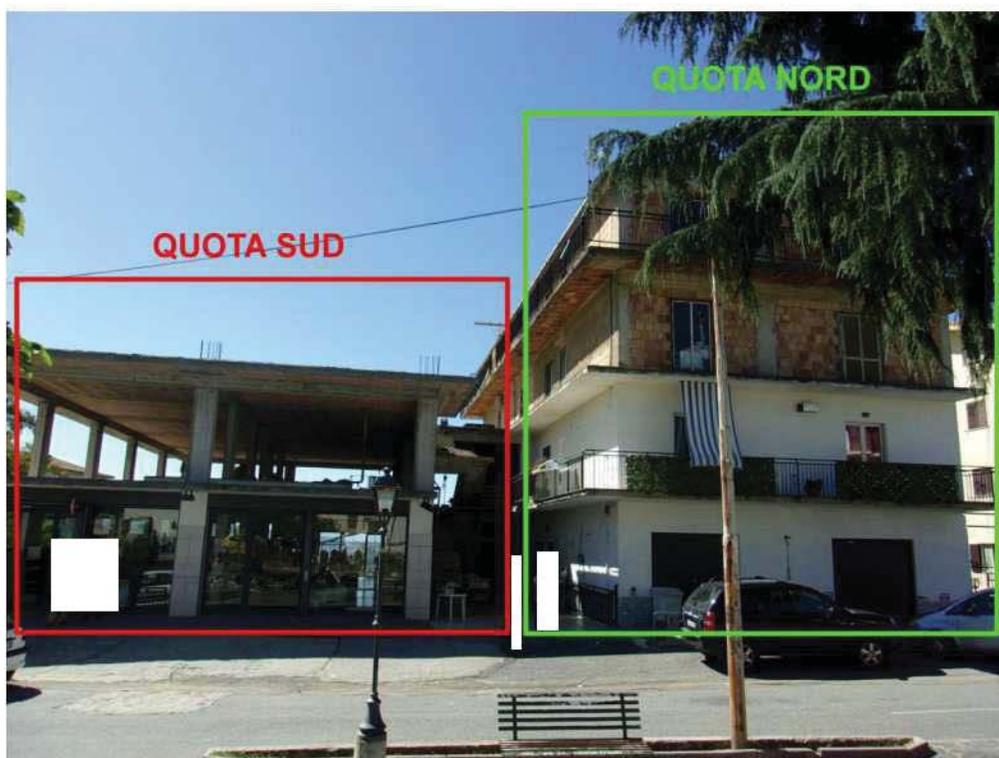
Prospetto frontale, lato nord/est Via San Marco.
